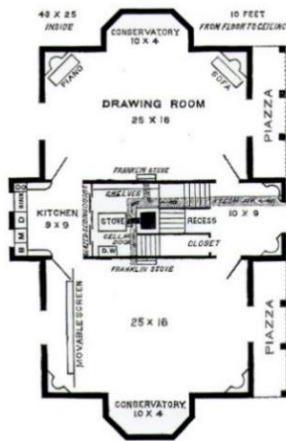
Planta do piso térreo e da cave da proposta da Casa Suburbana de Catherine Beecher.
